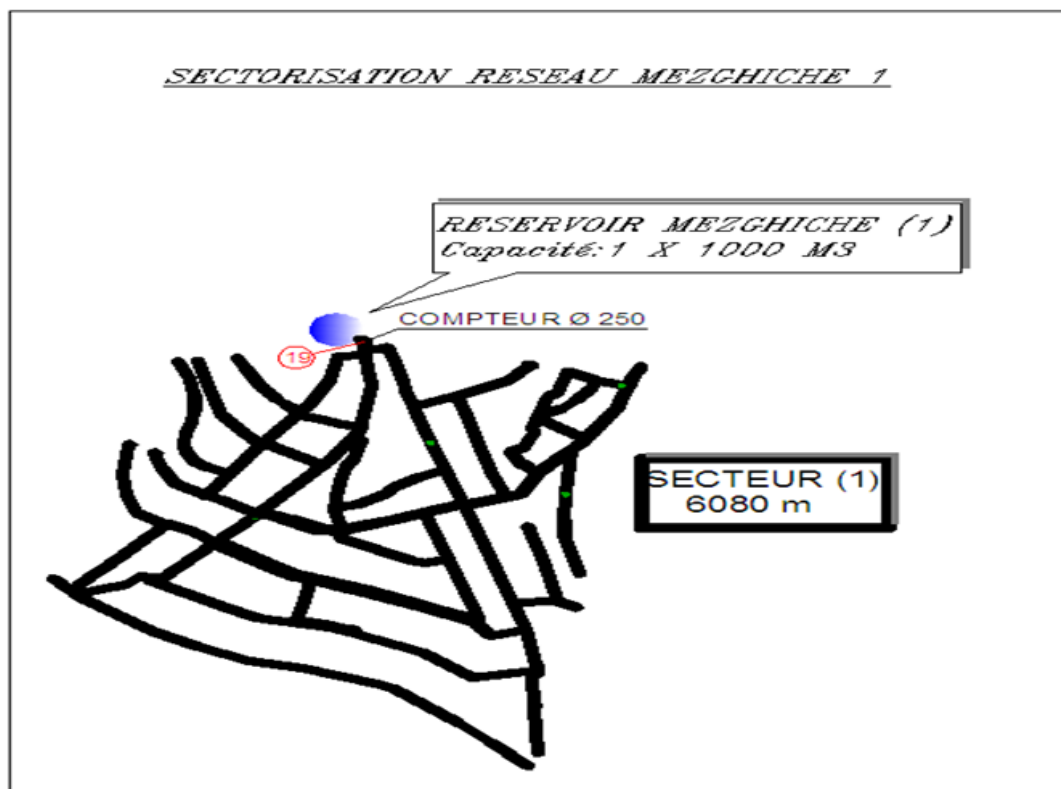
Plan de sectorisation du secteur Mezghiche1
